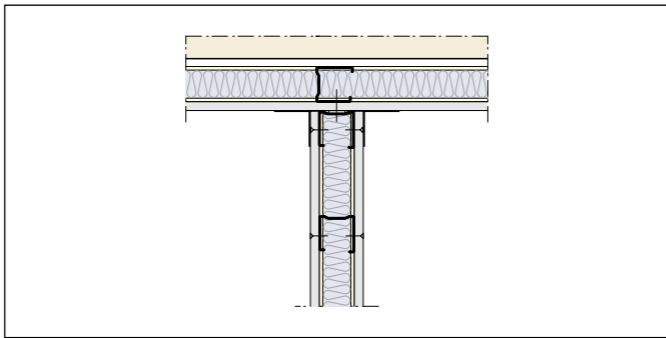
Gyproc voorzetwand - gevelconstructie - Gyproc plafond
